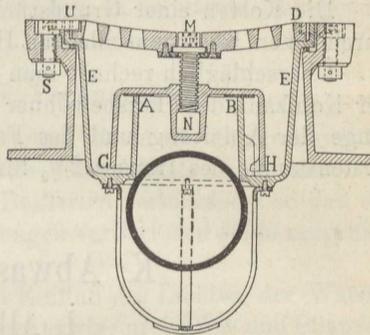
Doppelter Rückstauverschluß, System Oestreicher, in geschlossenem Zustande.
